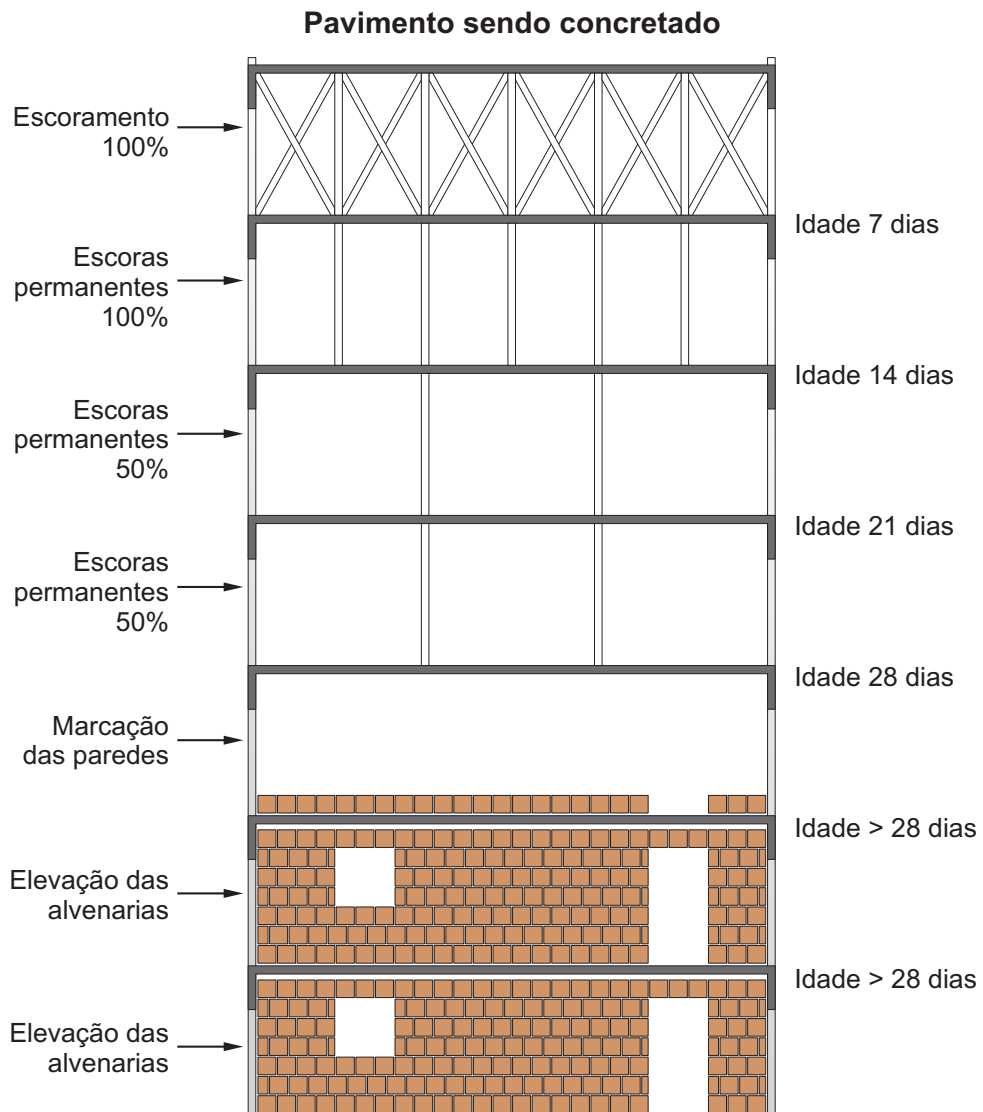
Etapas de concretagem da estrutura, marcação e elevação das alvenarias.
